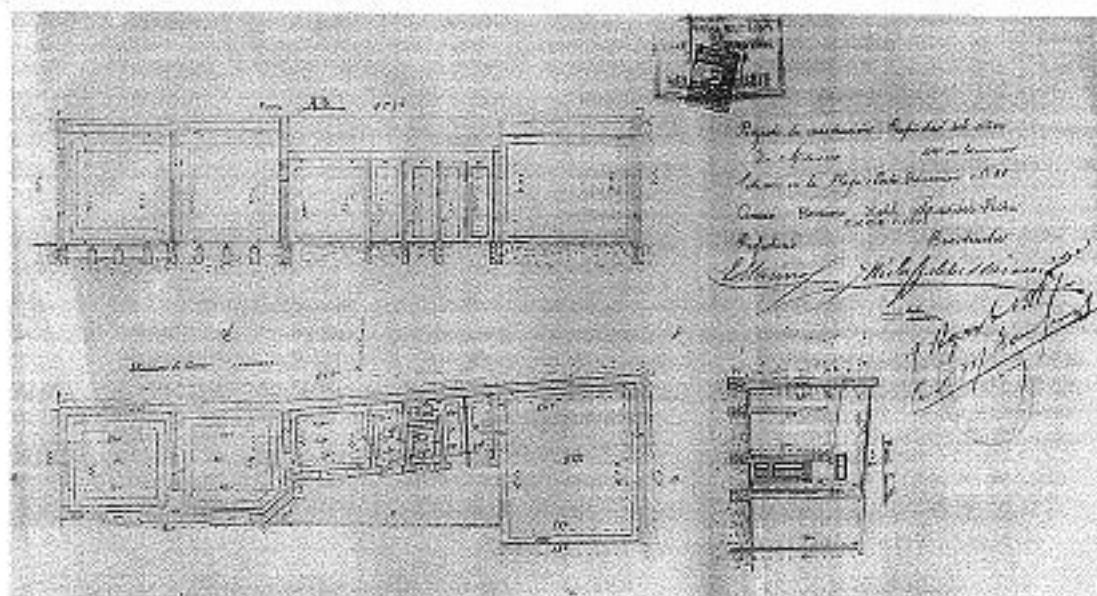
Obra construida por Alula Baldassarini en la rambla La Perla, sobre un plano de 1917.
